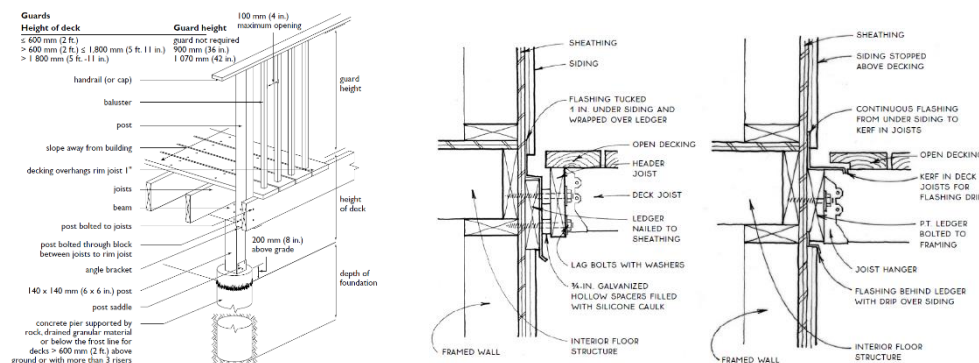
Varandas com "deck" (TRADA, 2008) e detalhes da ligação com a fachada (Thalon, 2009).
